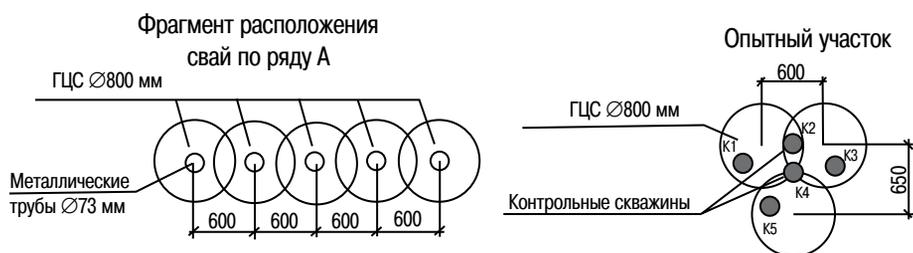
Схема расположения грунтоцементных свай в ряду. Опытный участок
